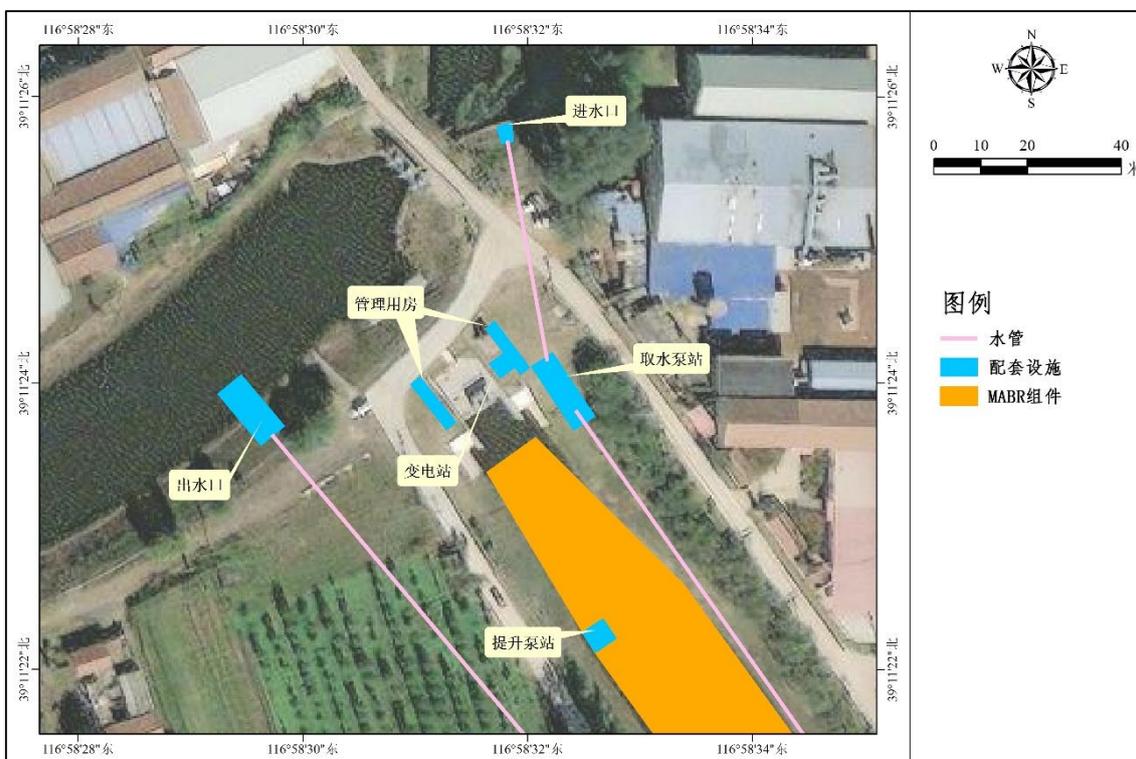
建设项目平面布置图（工程起点处局部放大图）
